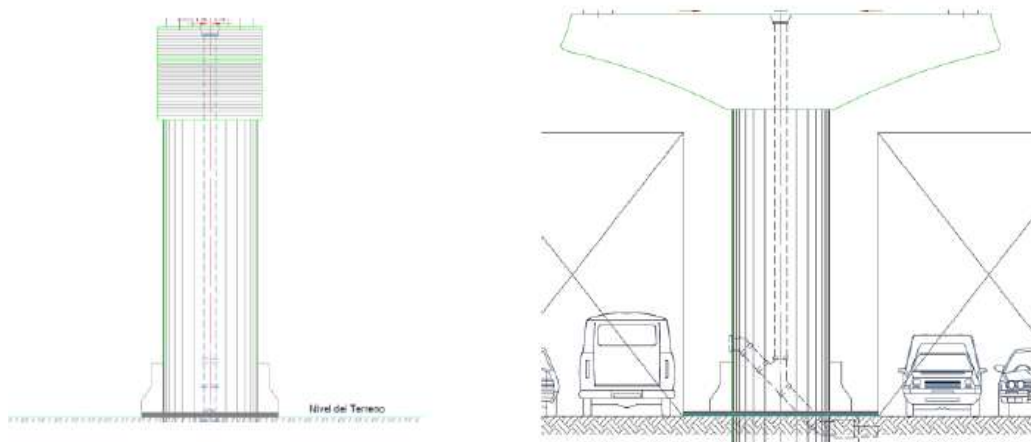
vista transversal cabezal pila del tramo elevado de la PLMB, opción para línea 2
